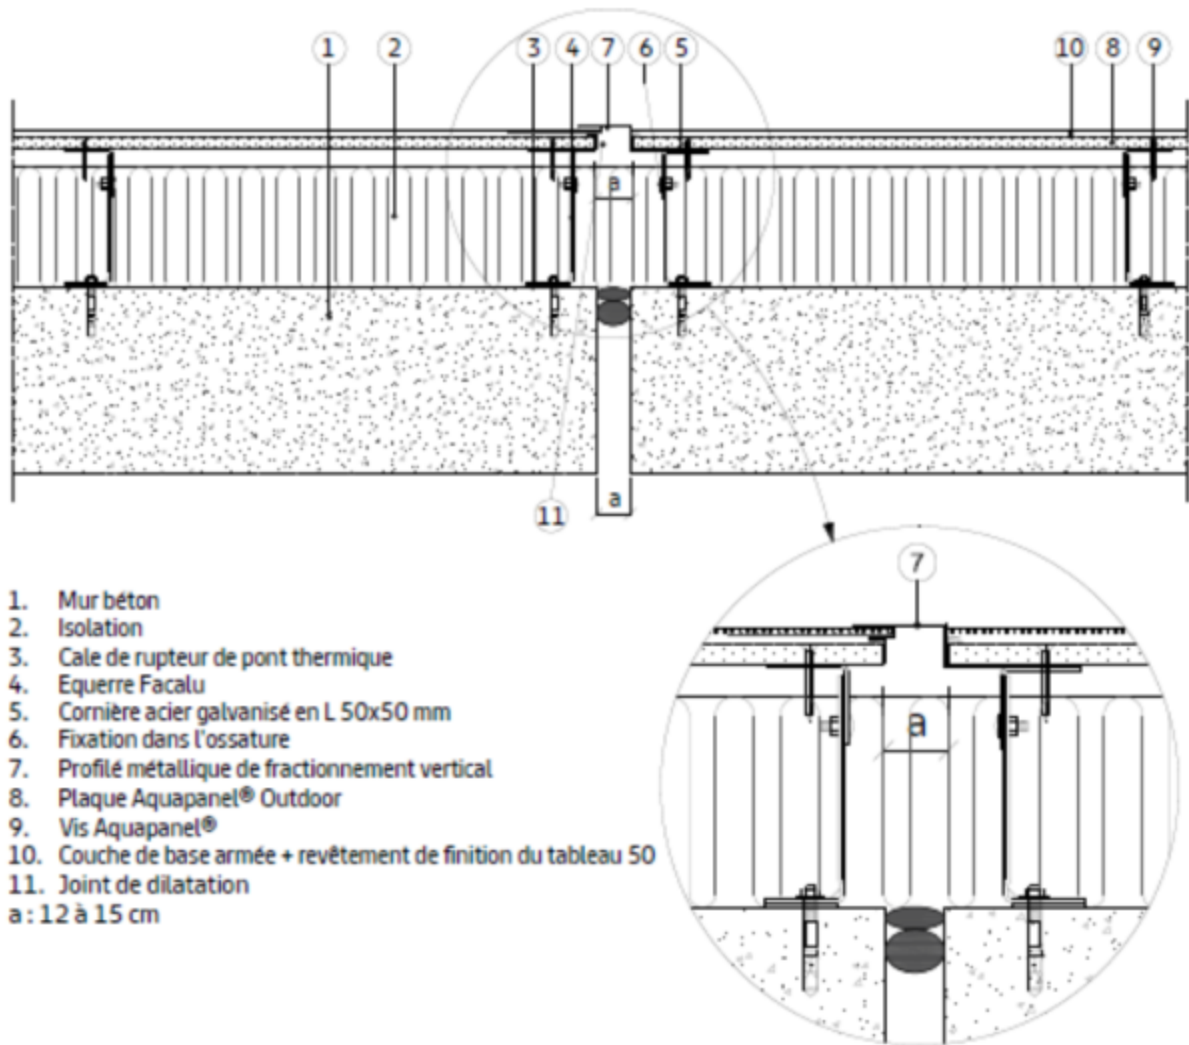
Traitement joint de dilatation vertical en zones sismiques (ossature acier) – Coupe horizontale
